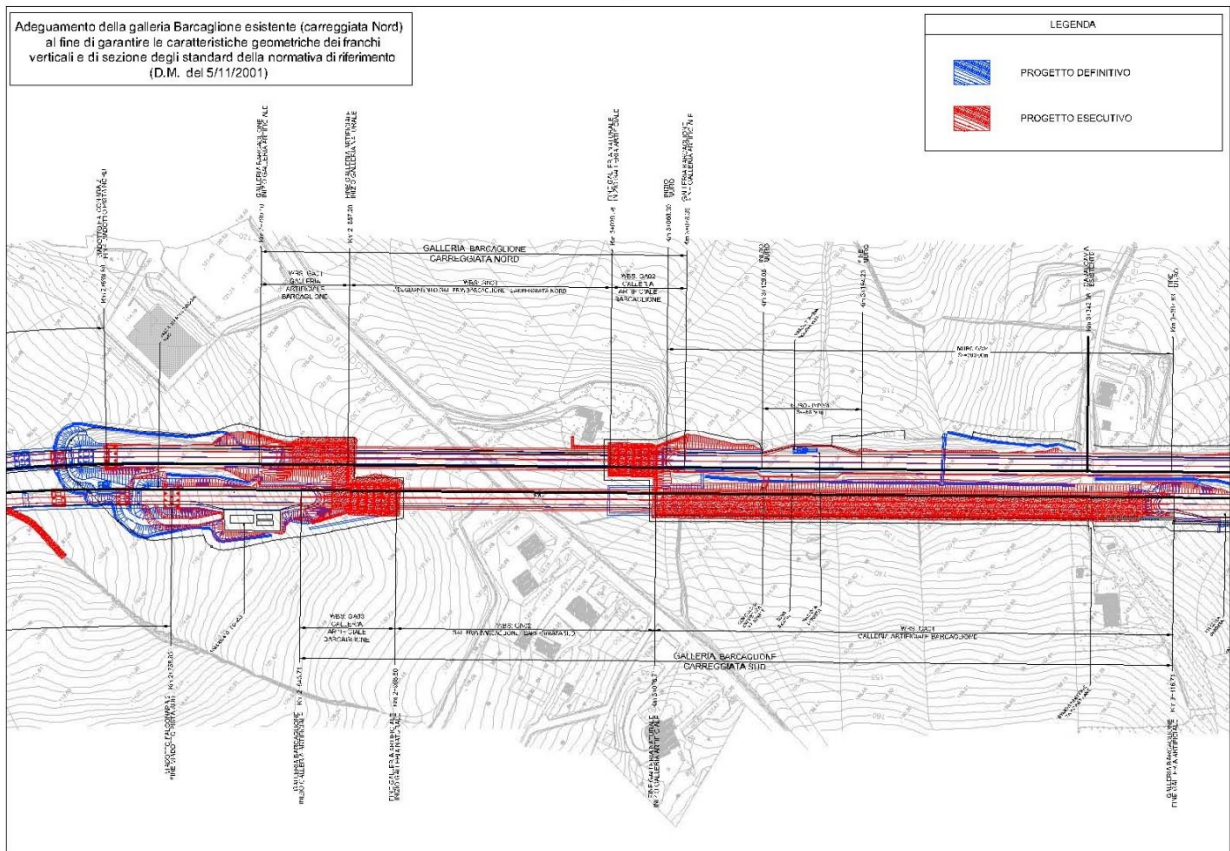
Sovrapposto planimetrico tra PD e PE nella zona Intervento 3 (galleria Barcaglione)
